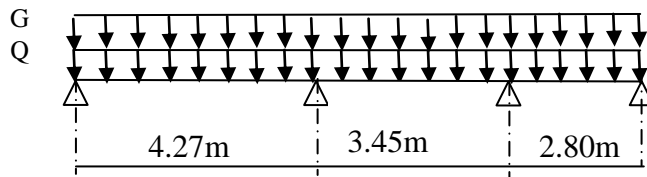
schéma statique d'une poutrelle type 1 (étage bureau)
